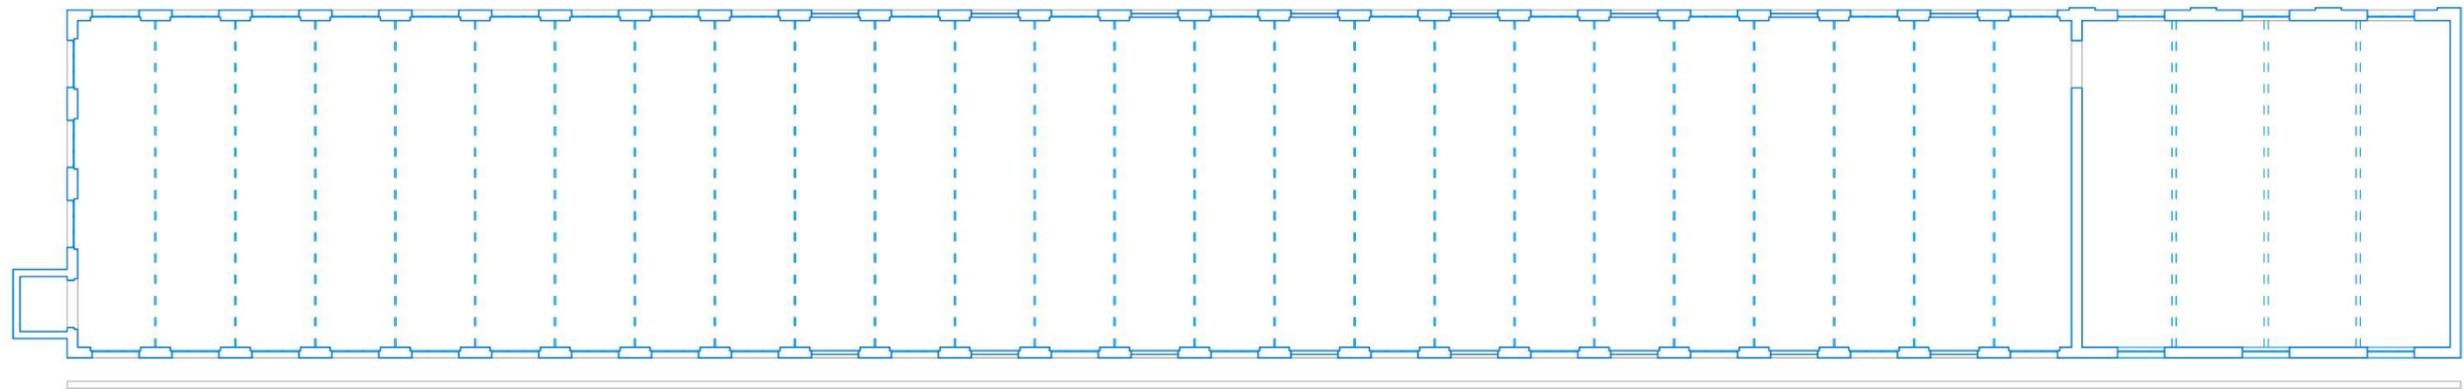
PLANO 1/300. Planta primera pre intervención nave G original fábrica Fabra i Coats.
